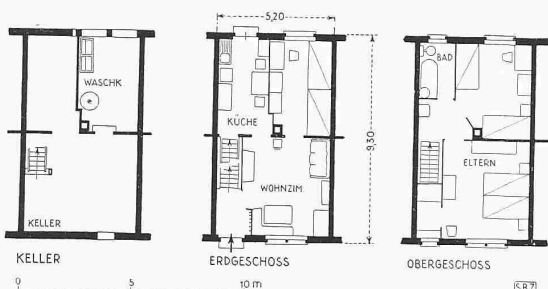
Grundrisse des eingebauten Einfamilienhauses Typ A. 1:300
